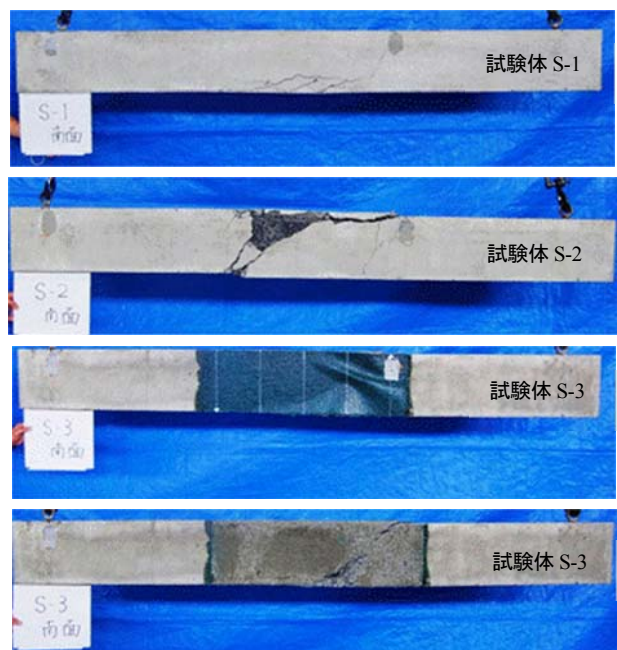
各試験体のひび割れおよび終局的破壊性状
